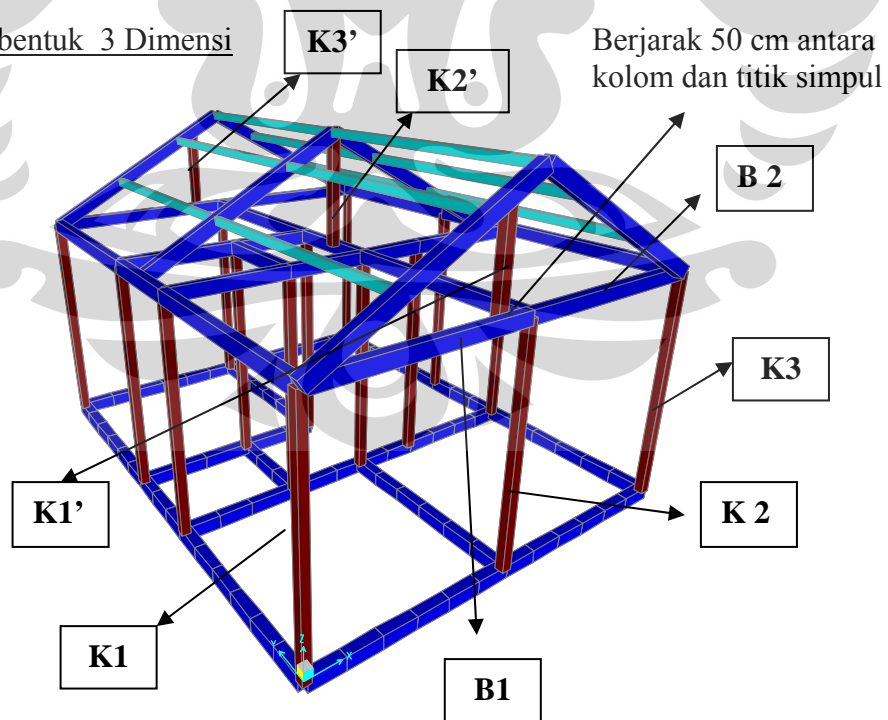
Bentuk struktur model dua pada bangunan satu lantai
